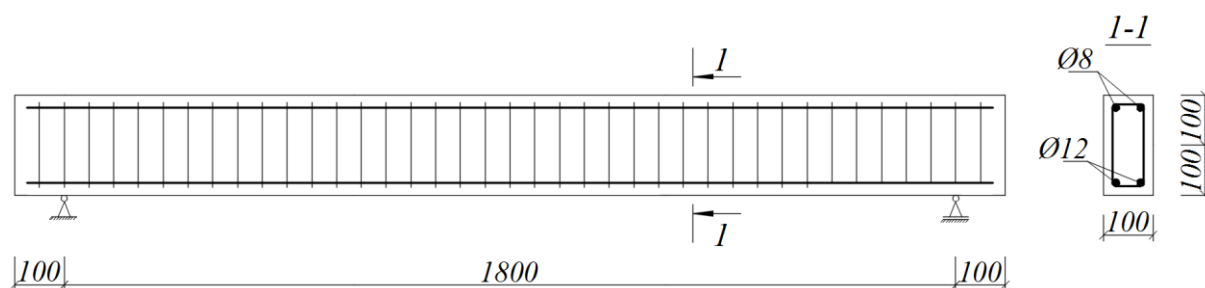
Армування залізобетонної та сталеві фібробетонних балок стержневою арматурою
